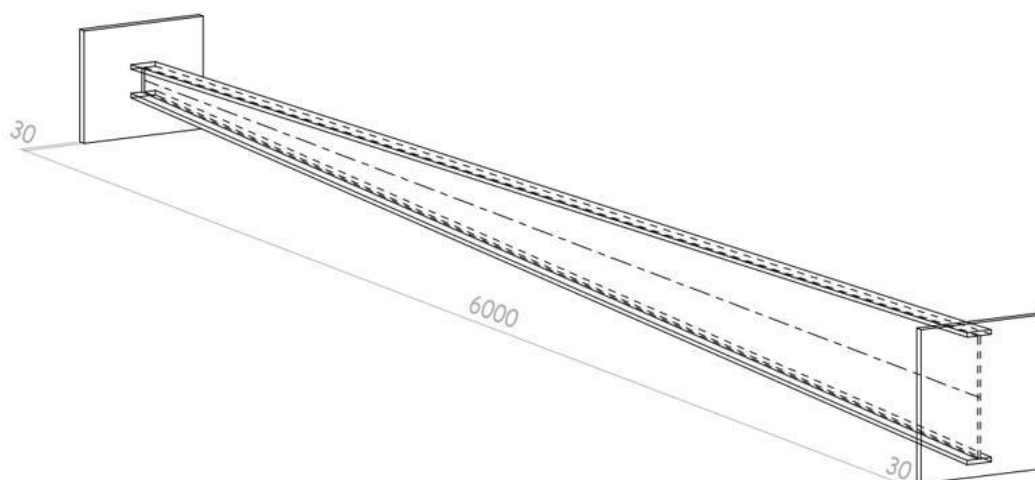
Esquema de configuração geométrica do elemento coluna.
